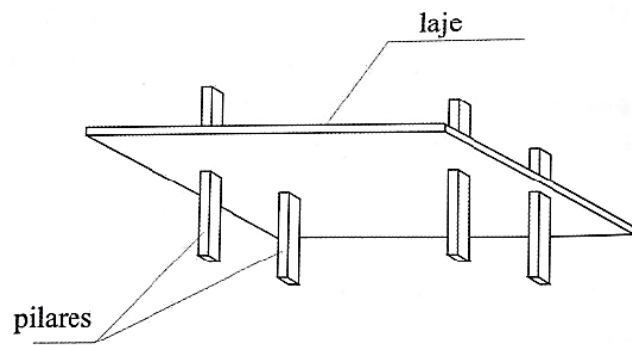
Perspectiva de um painel de laje sem vigas (CARVALHO e PINHEIRO, 2009).
